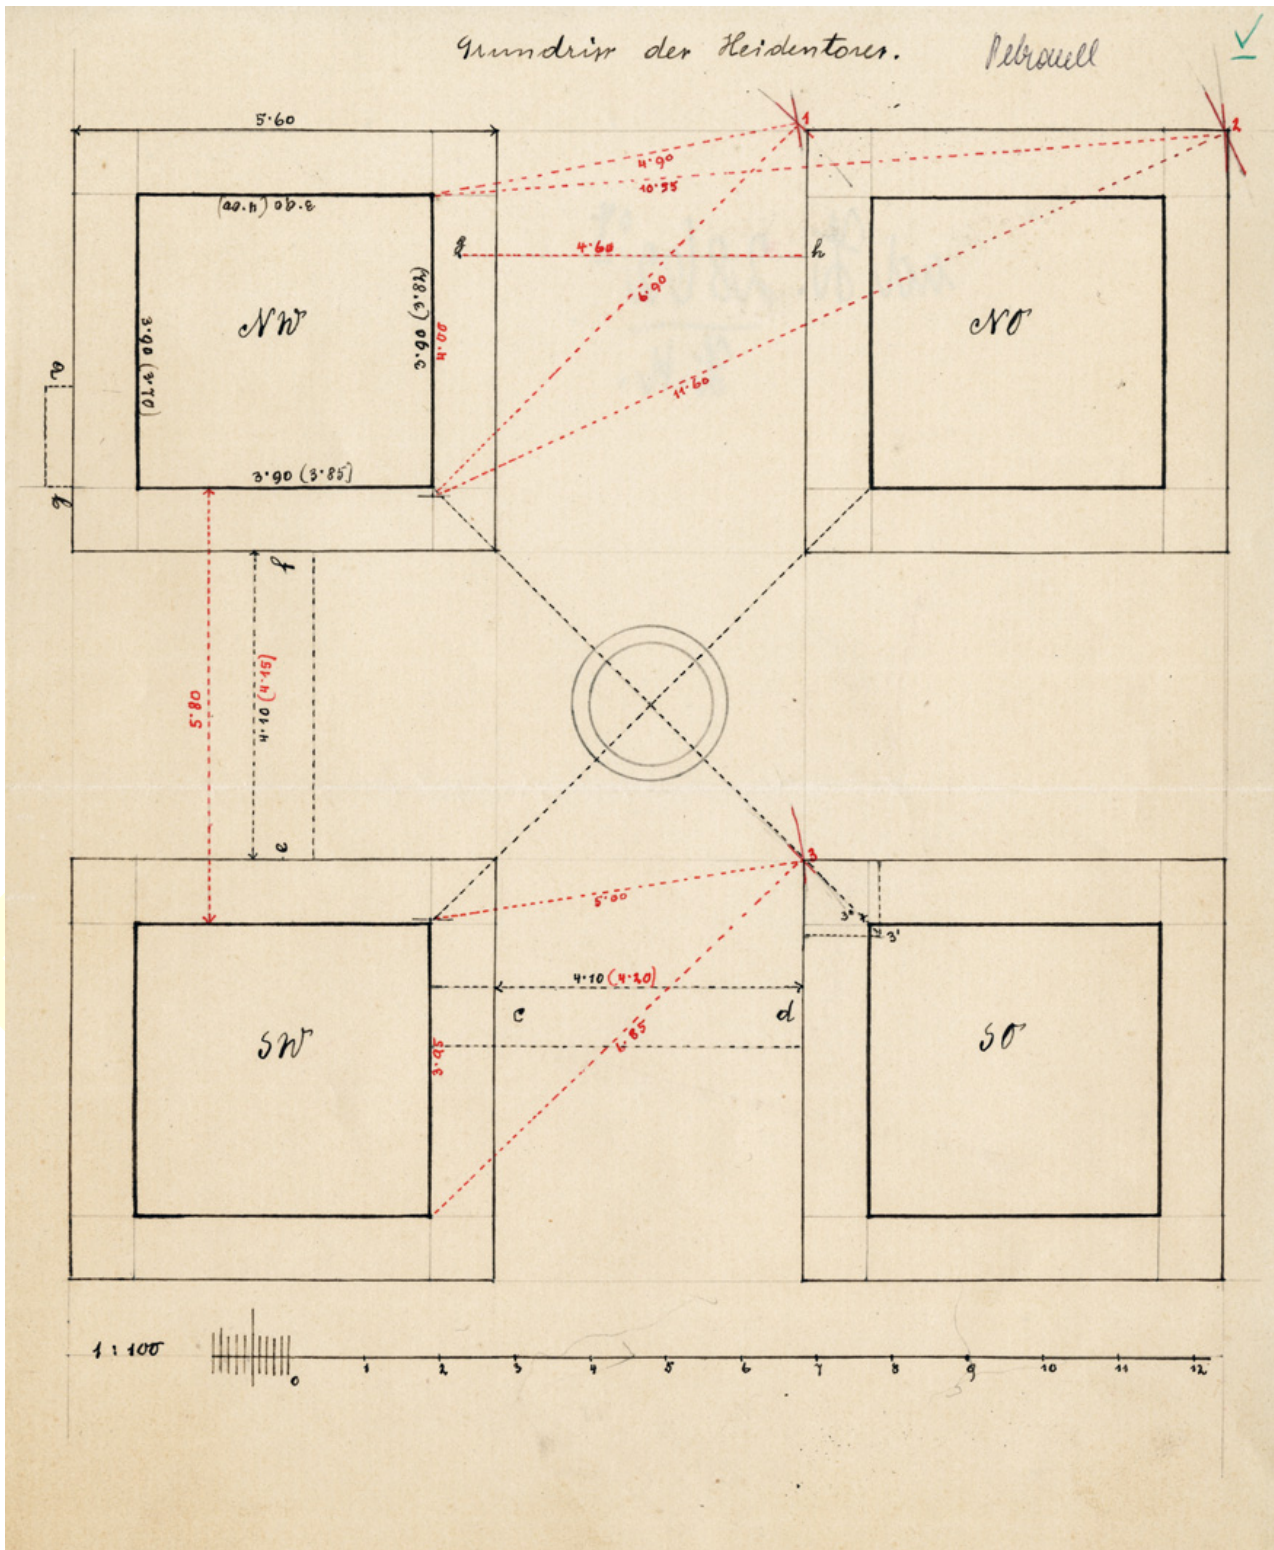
Petronell/Carnuntum. Grundrissplan aus dem Originalbericht zur Restaurierung des Heidentores 1907 (maßstabsgetreue Wiedergabe).
